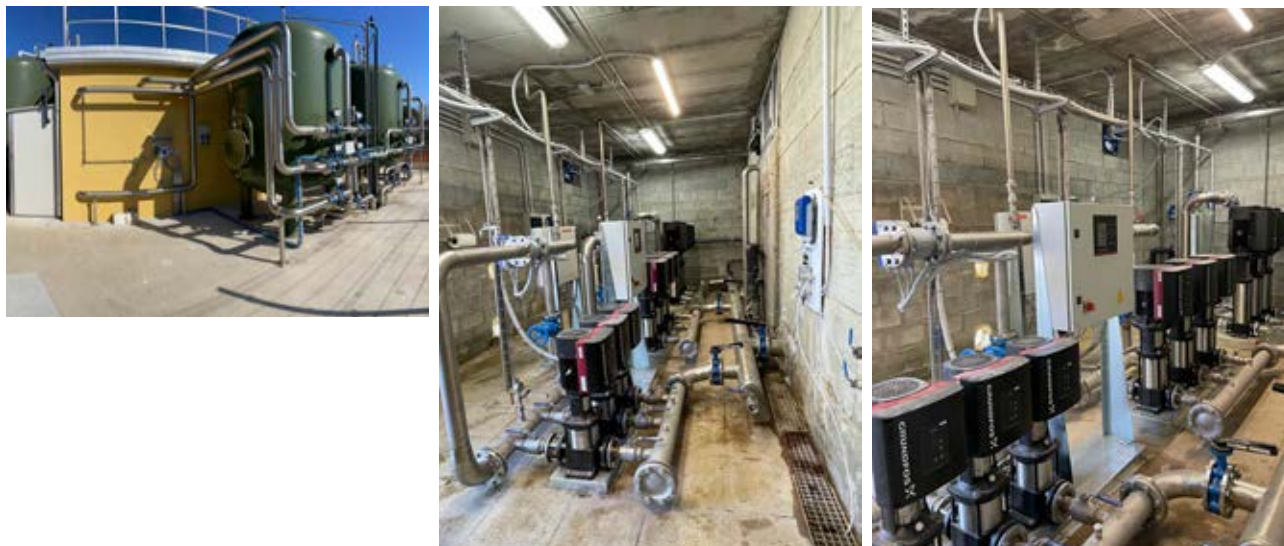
8 e 9: Lavori revamping impianto di potabilizzazione Cesa, Marciano della Chiana
